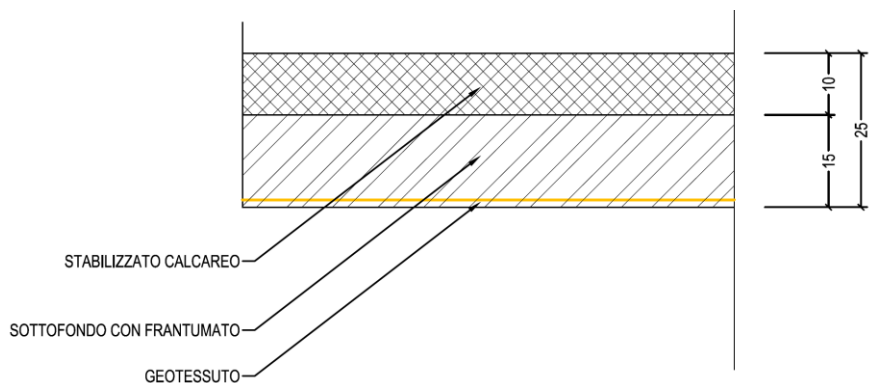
Sezione tipo del pacchetto costituente la viabilità interna
